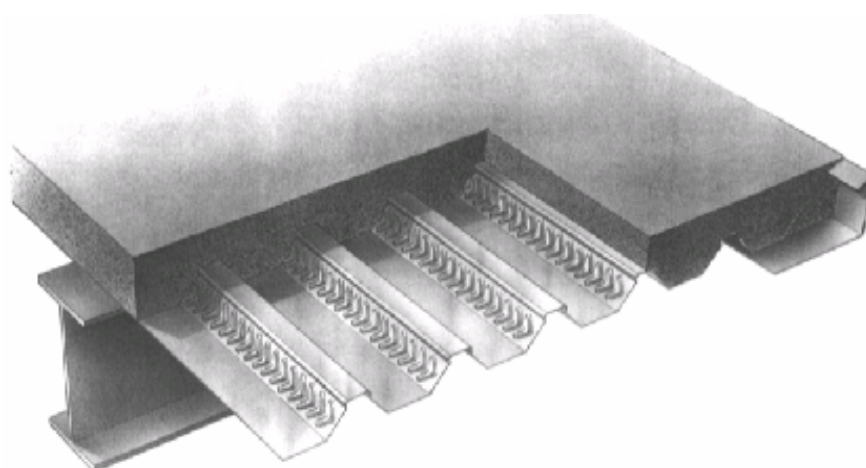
Exemplo de laje mista aço-concreto
